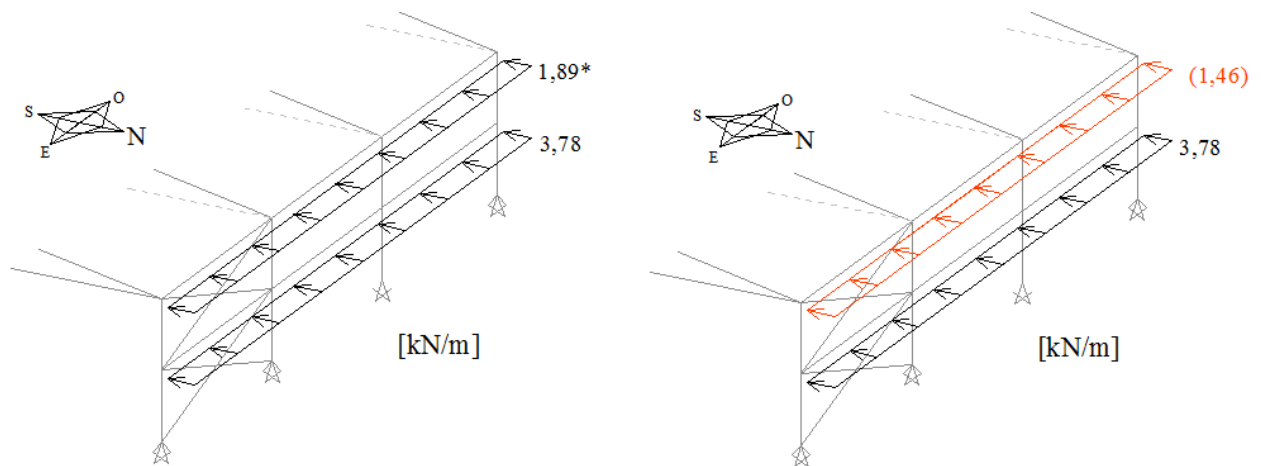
Vento W1 na fachada orientada a Norte na situação 1 (RSA)
